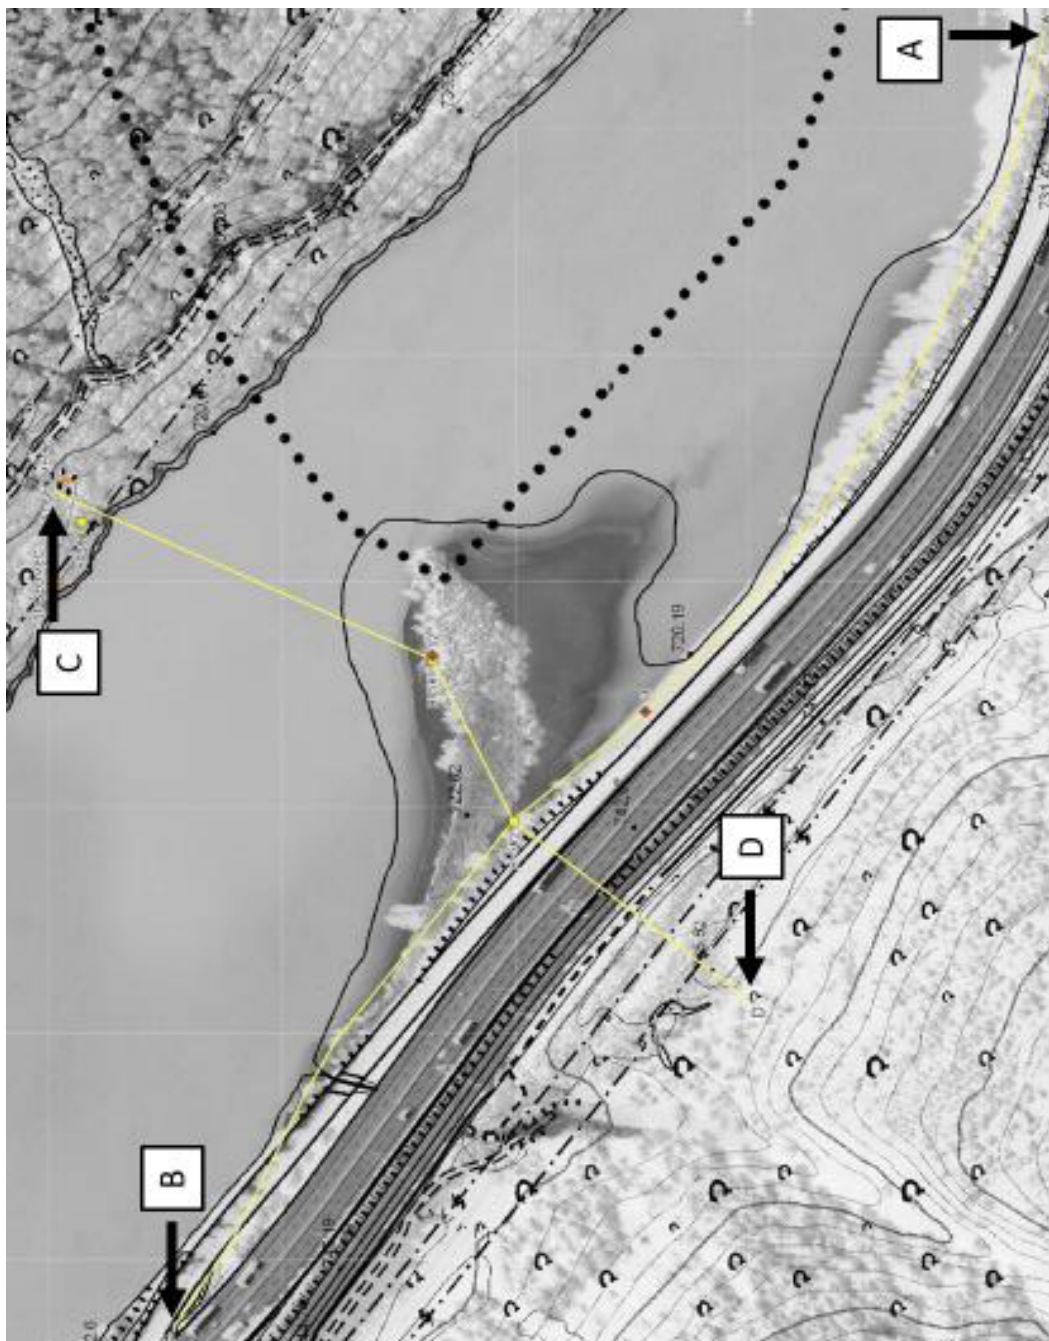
Stralcio dell'Allegato 3 che riporta le tracce delle sezioni AB e CD in planimetria / Auszug aus der Anlage 3, mit Angabe der Schnitte AB und CD im Lageplan
